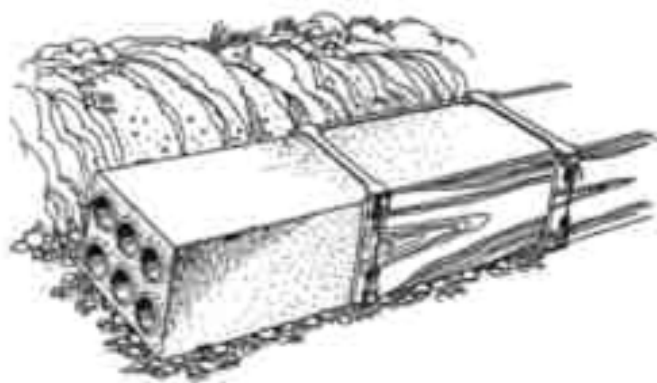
(RT9169) Illustrasjon av tverrsnitt av grøft med betongkanal med lokk 40 cm overdekning
